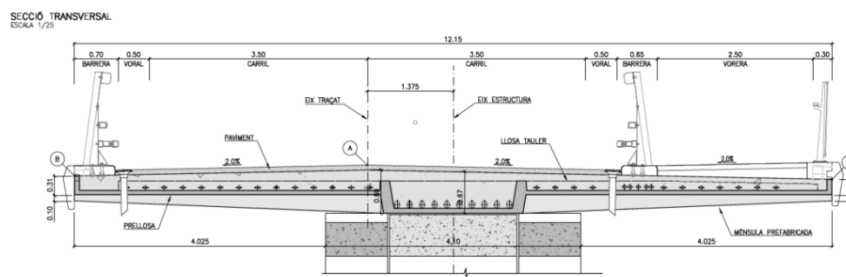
Secção transversal da ponte (fonte: Planos de Projeto Modificados)
